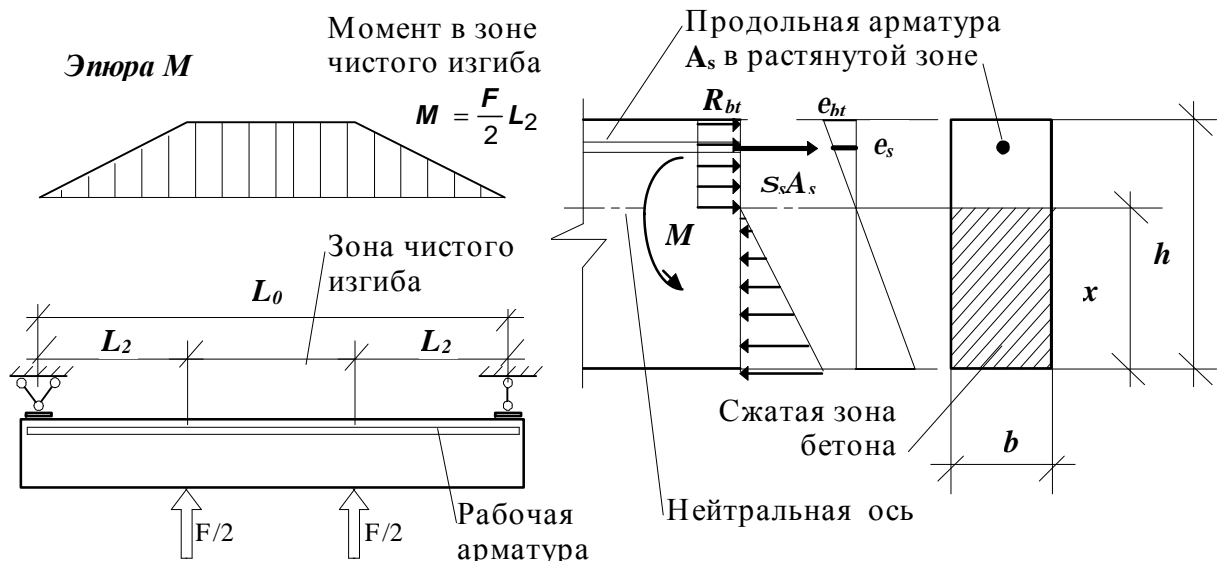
Схема усилий в нормальном сечении балки при расчете на образование трещин
